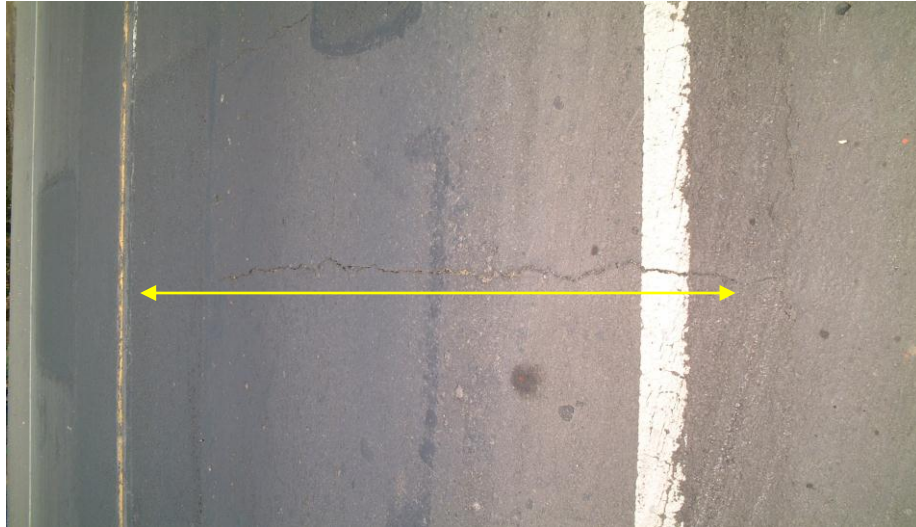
Fotografía de calzada con presencia de fisura transversal.
